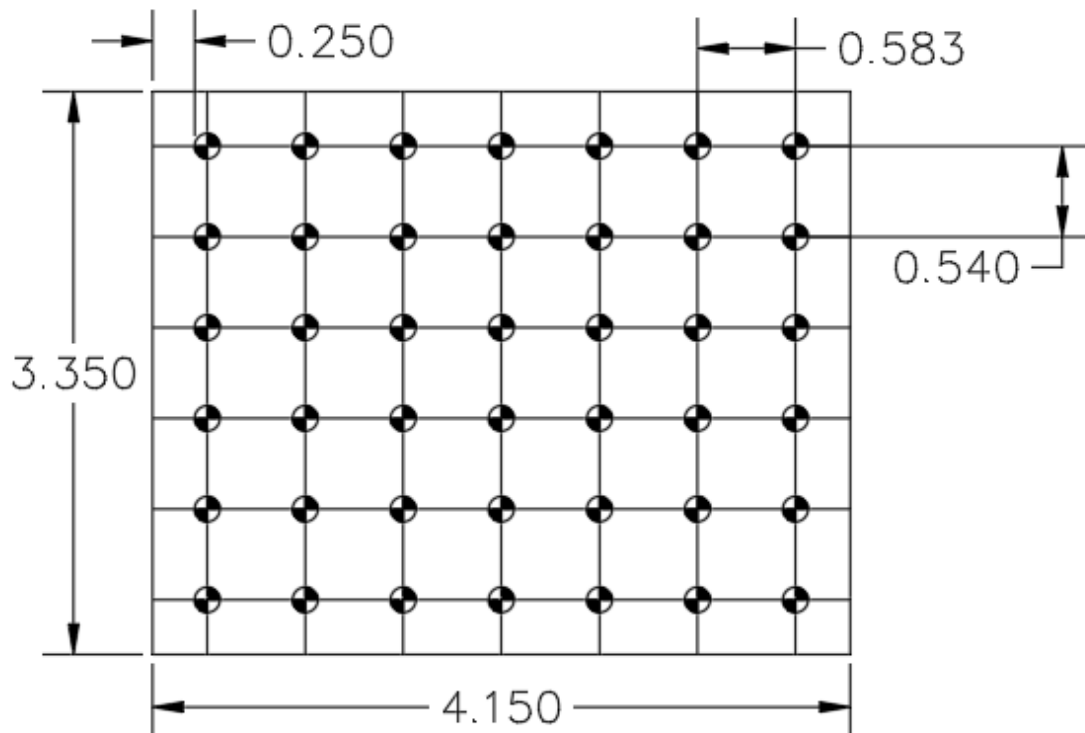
Diseño final encepado N1246 con pilar articulado
